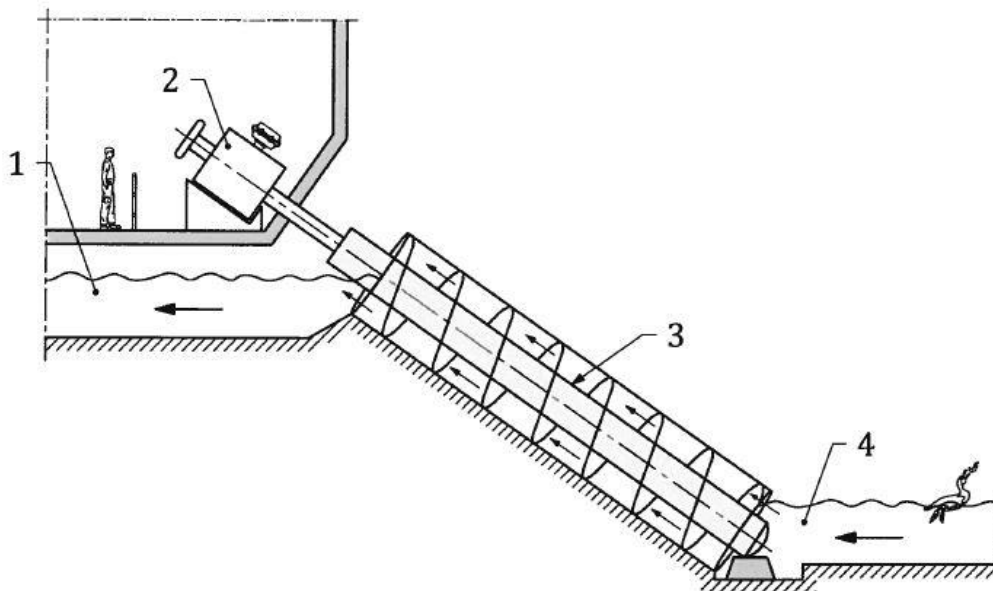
Querschnitt eines Schöpfwerks mit Wasserförderschnecke (1 = Druckseite, Wasserabgabe, Unterlauf des Gewässers, 2 = Pumpenmotor, 3 = Wasserförderschnecke, 4 = Saugseite, Wasseraufnahme, Oberlauf des Gewässers; Pfeile = Fließrichtung, Förderrichtung). Der (anadrome) Fischaufstieg im Gewässer erfolgt gegen die Fließrichtung, der (katadrome) Abstieg in Fließrichtung (aus NEN 2020).
